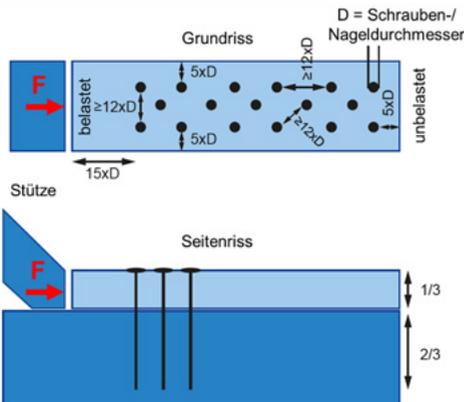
Nagelbild einer Knagge (Blockhaus, THW)
